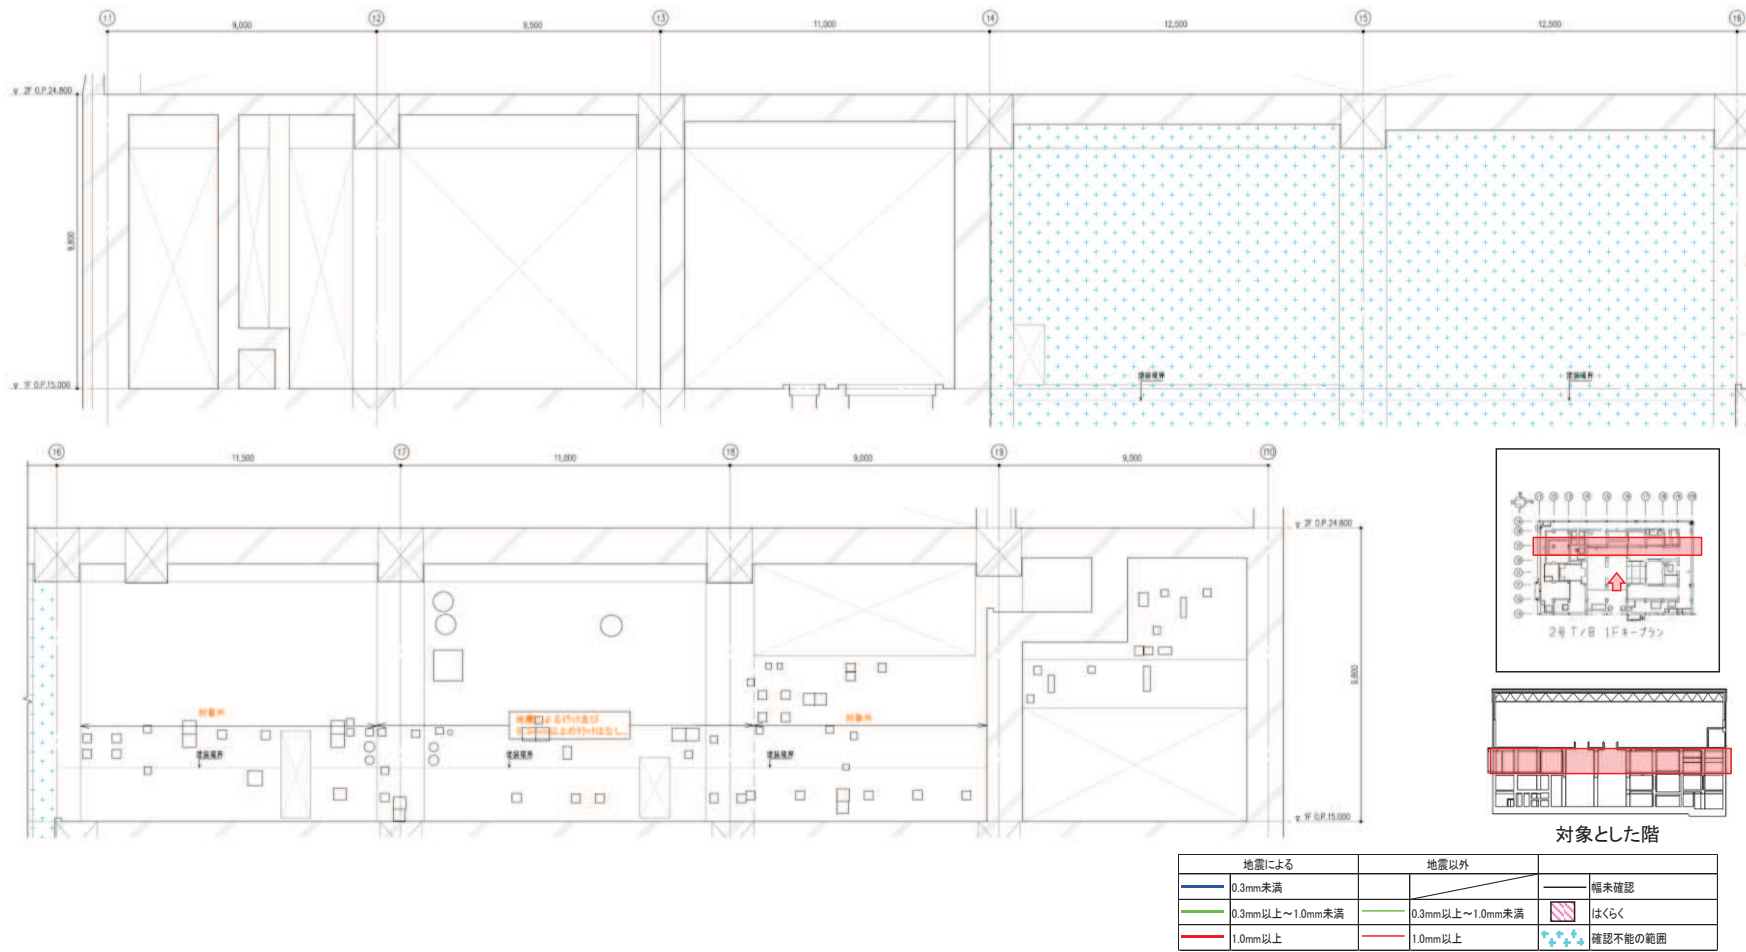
タービン建屋のひび割れ分布 耐震壁 (44) 1階 TC 通り
